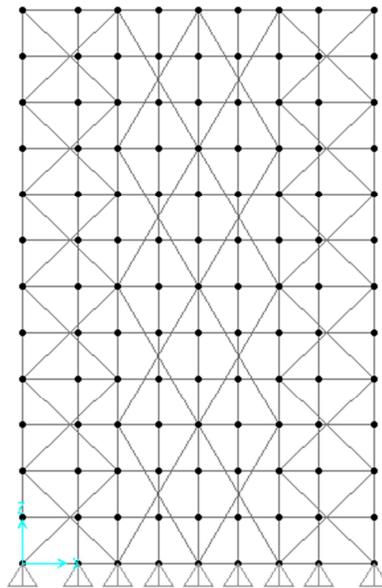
Configuração dos Planos de Contraventamento Vertical Com Elementos de Contraventamento Grandes
